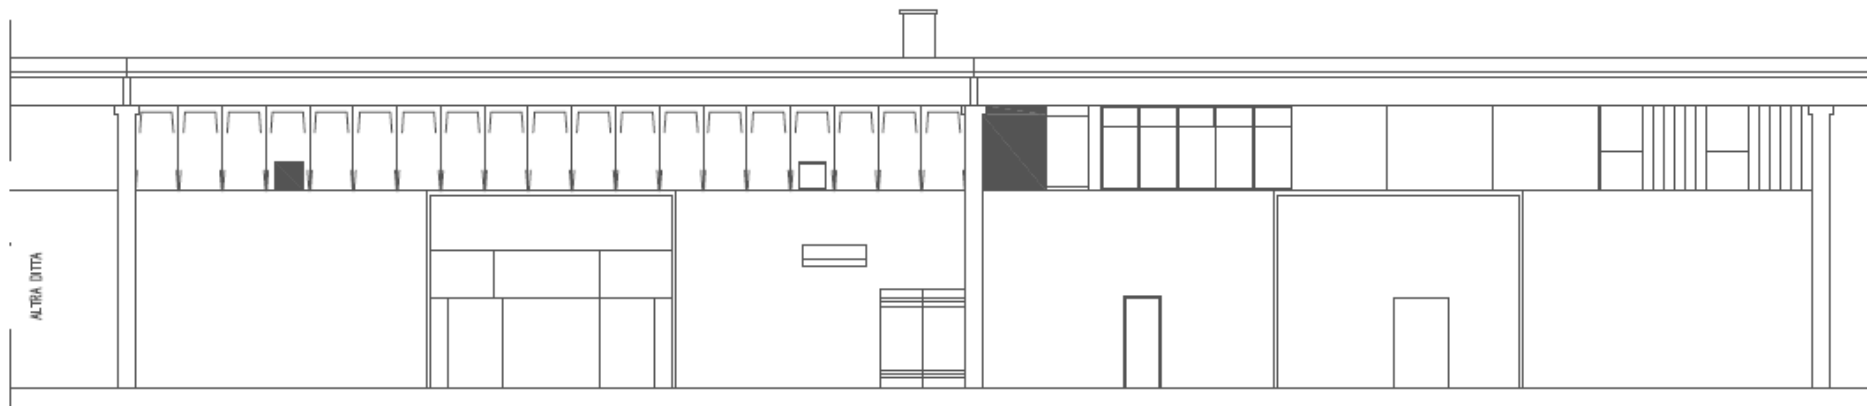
Prospetto dell'ingresso principale dello stabilimento.
